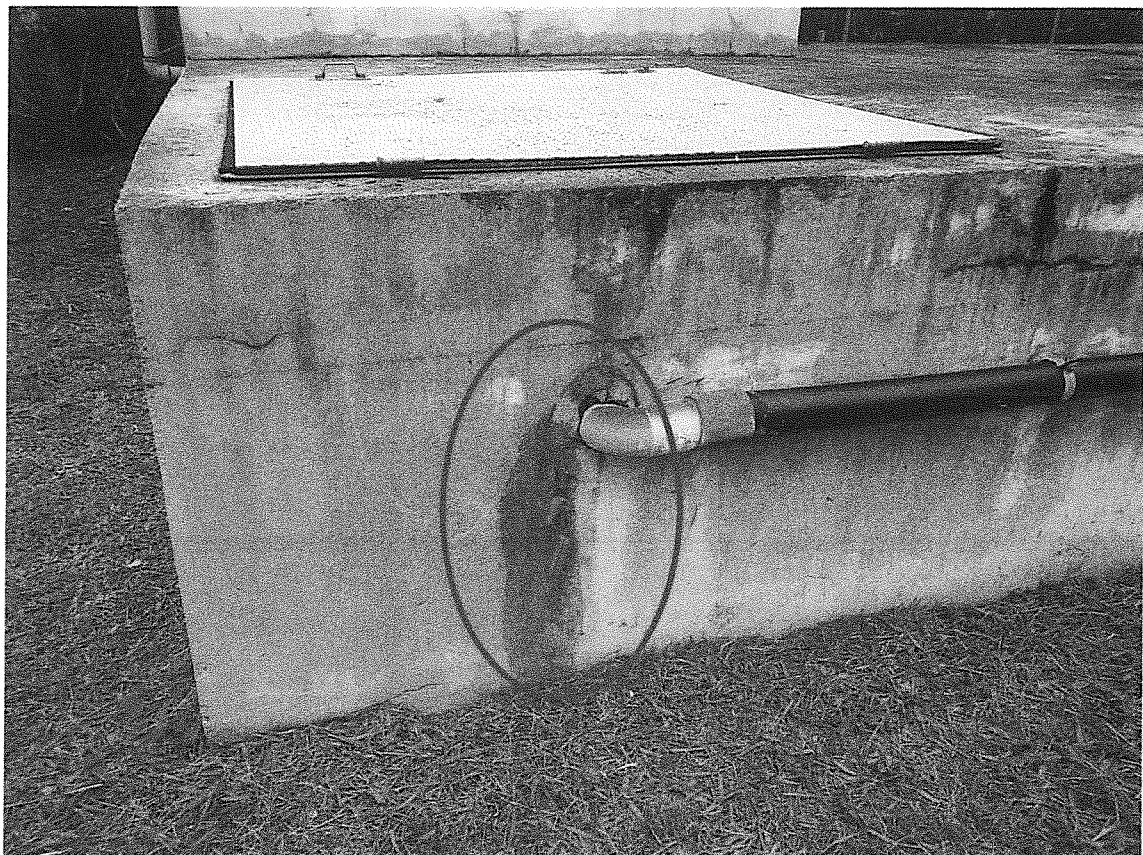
fuite au niveau de la conduite de recirculation des boues
